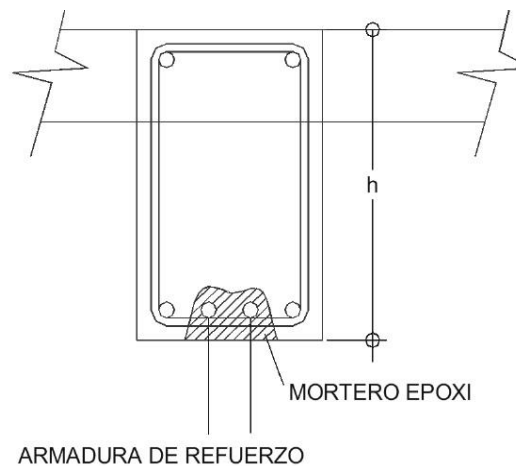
Adición de armaduras de refuerzo sin recrecido de la sección de la viga para refuerzo a flexión, esta se cierra con mortero epoxi.
